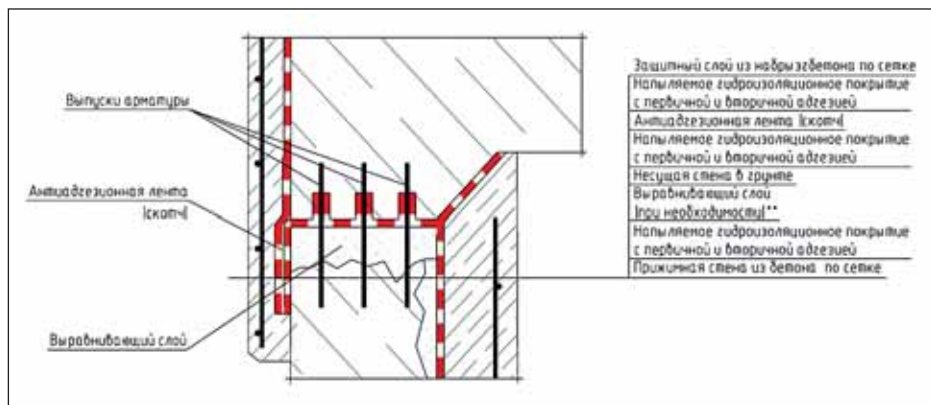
Устройство гидроизоляционной системы при открытом способе работ с использованием «стены в грунте» в качестве несущей. Узел 2
